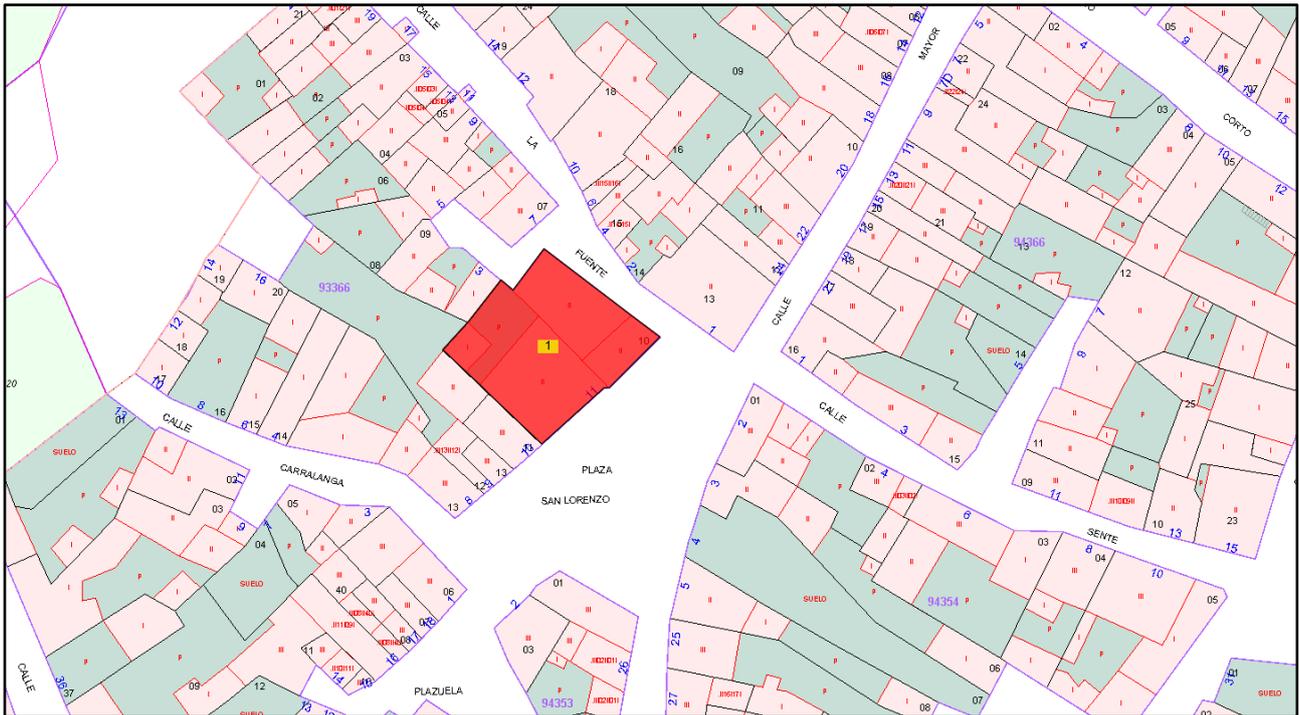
Plano de emplazamiento del Edificio objeto del estudio.
